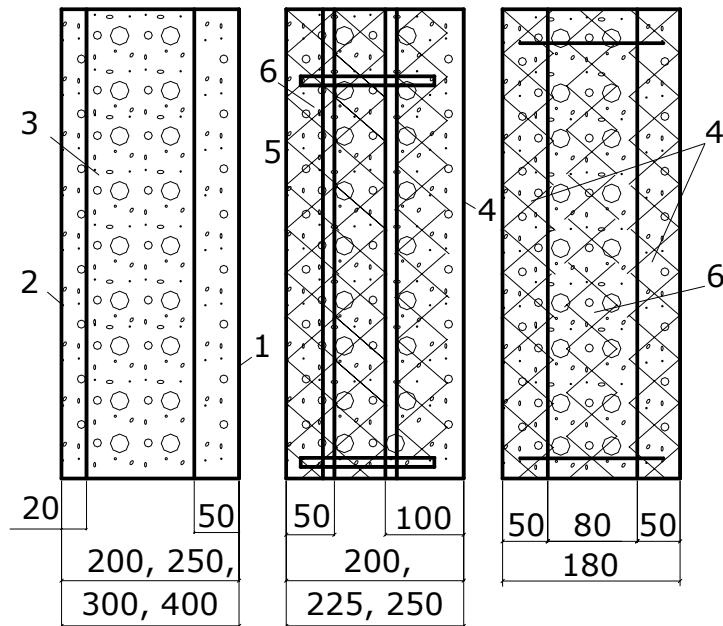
Конструктивні схеми панелей: а-двошарові; б-тришарові на гнучких в'язях; тришарові з жорсткими в'язями; 1-захисний шар з бетону класу В15; 2-розчин марки 100; 3-легкий бетон класу В30; 4-залізобетонна несуча плита; 5-зовнішній бетонний шар; 6-утеплювач
